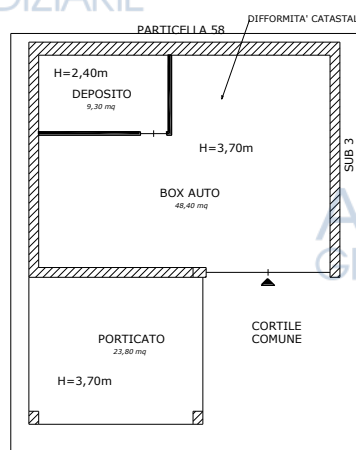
planimetria del box auto, del deposito e del porticato al piano terra
